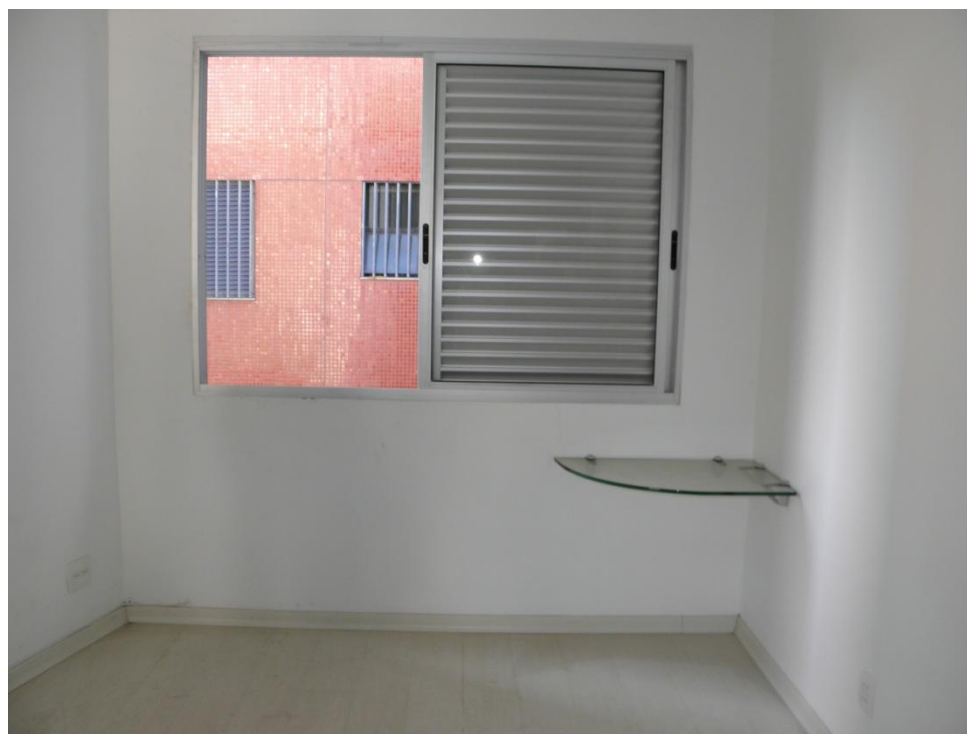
Vista do prolongamento da mesma fissura longitudinal
